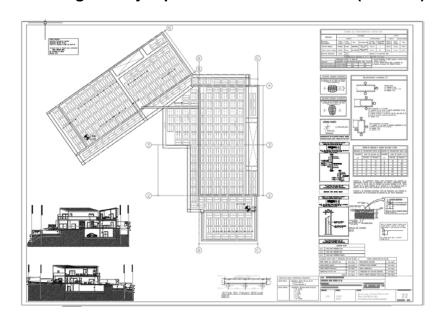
Ejemplo Planos Estructurales (BERLIN).
